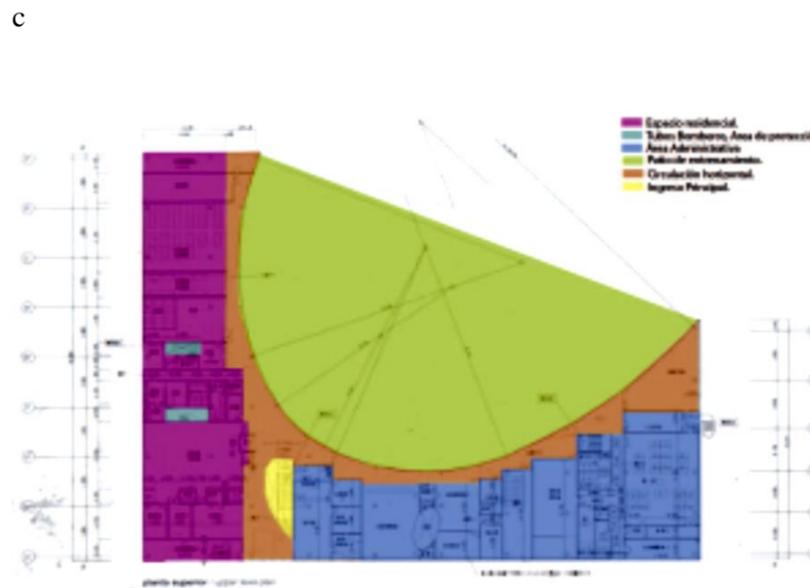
PRIMERA PLANTA<sup>51</sup> [IMAGEN# 11]
